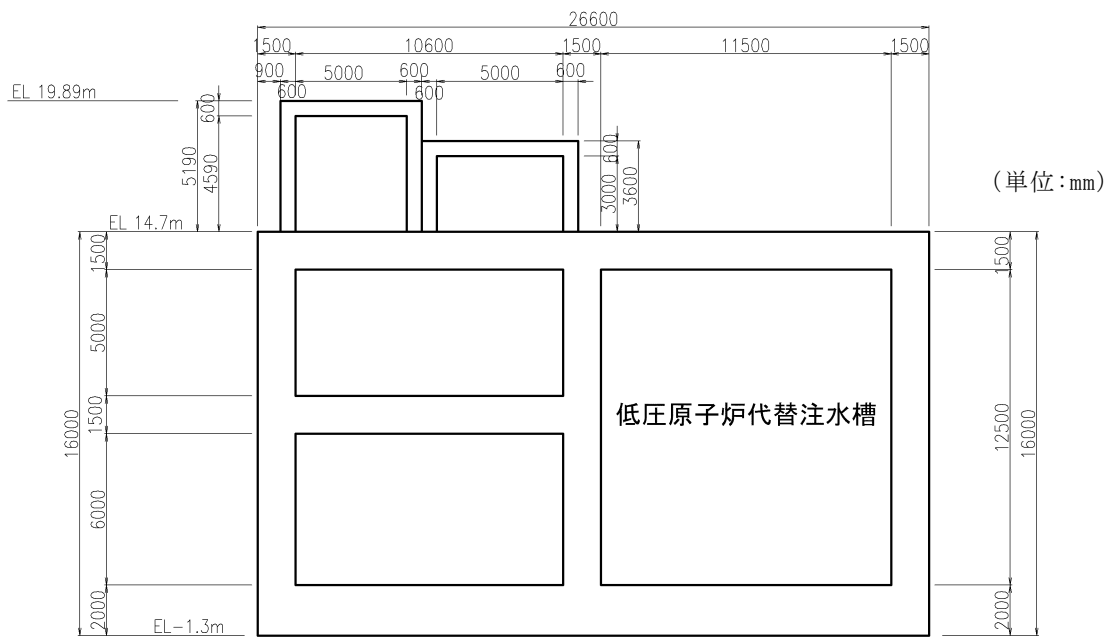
低圧原子炉代替注水ポンプ格納槽 断面図 (C-C断面)
